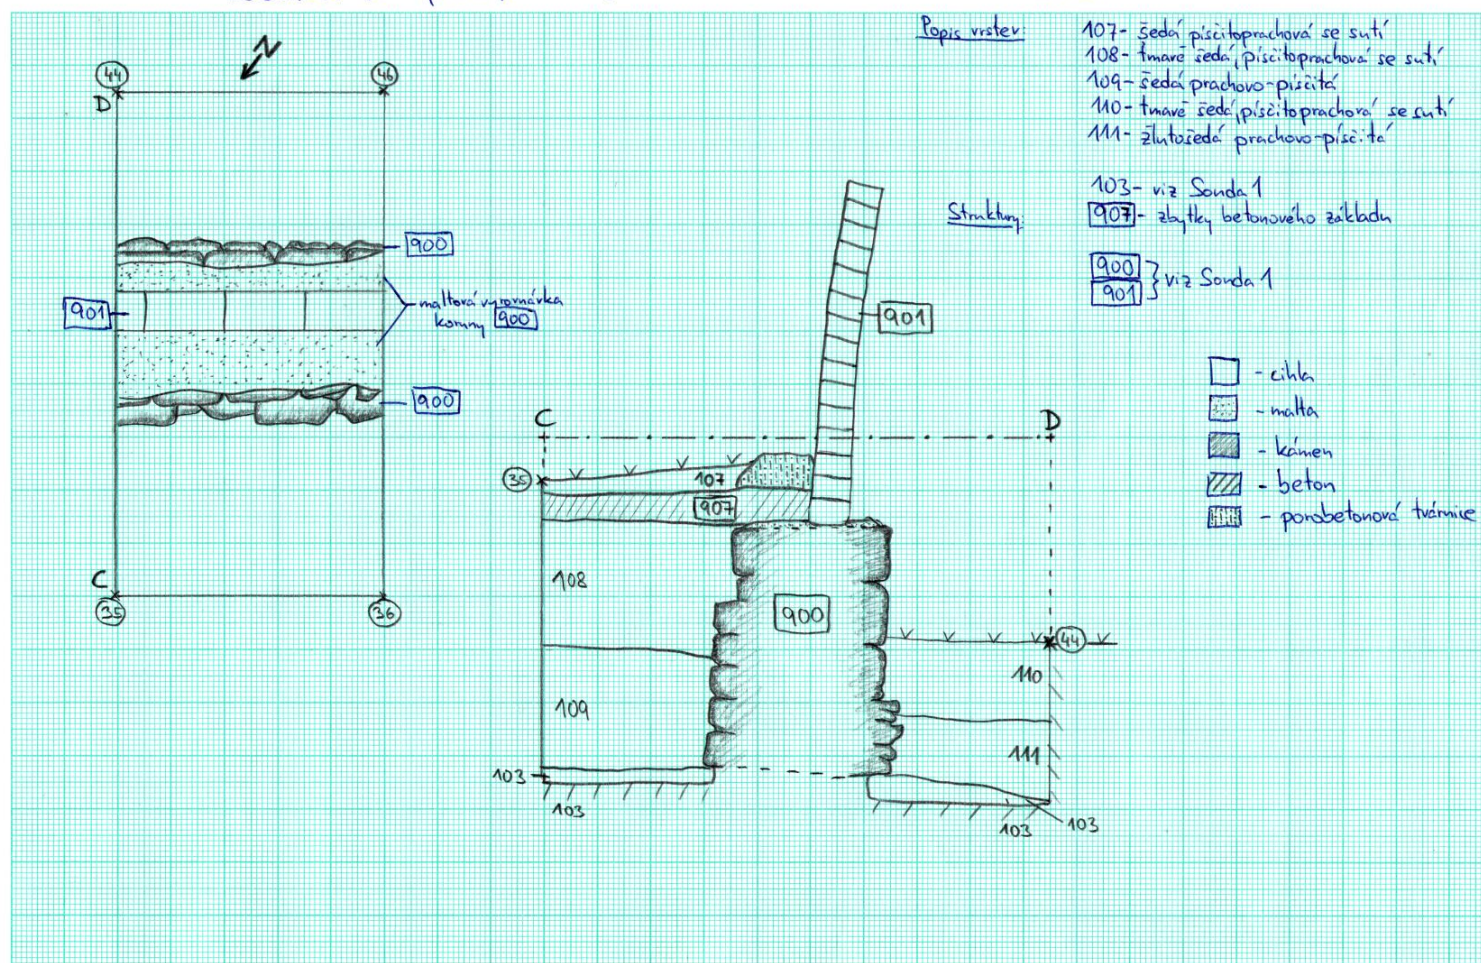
Kladruby nad Labem (okr. Pardubice): Zámecká zahrada – Sonda 2, vnitřní obvodová stěna, západní pohled
